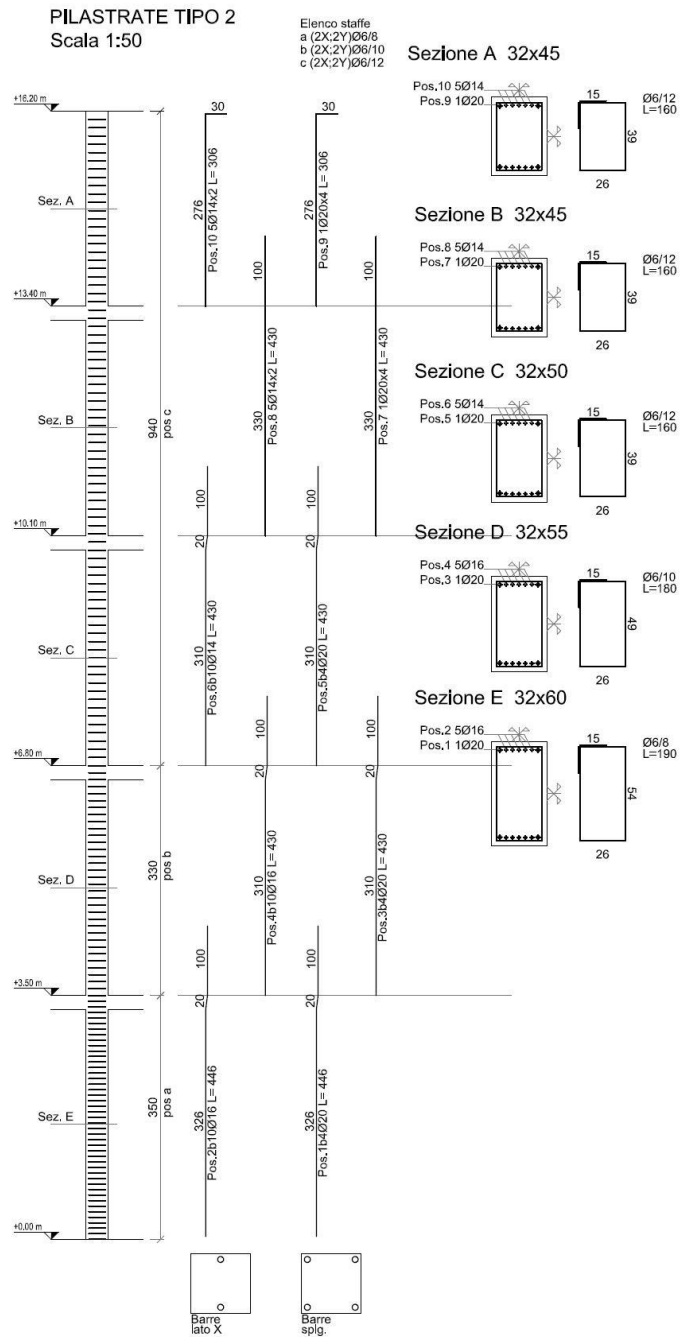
Armatura longitudinale e trasversale per pilastri di tipo 2.
